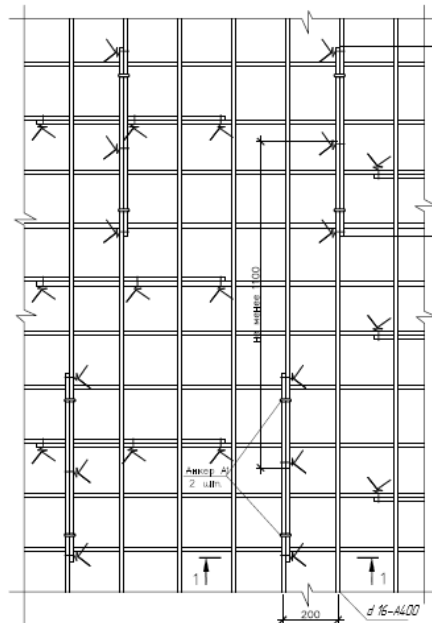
План стыковки верхней и нижней зоны армирования фундаментной плиты
